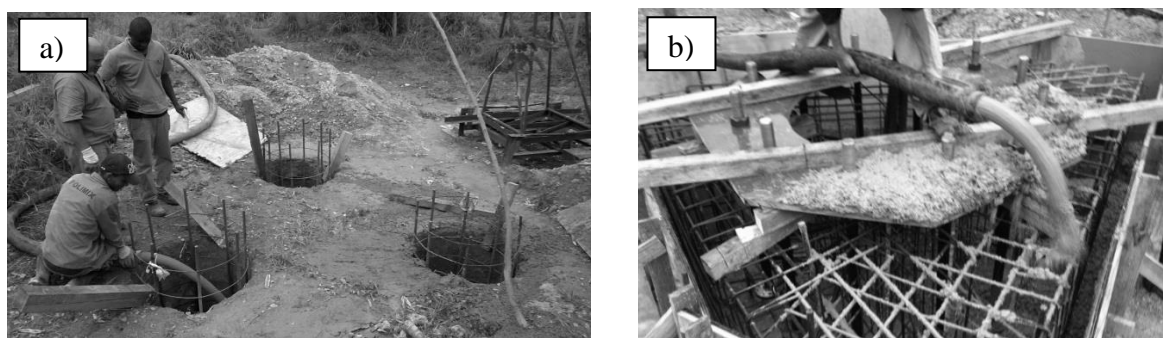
Concretagem dos tubulões e bloco de coroamento. a) Tubulões; b) Bloco.
